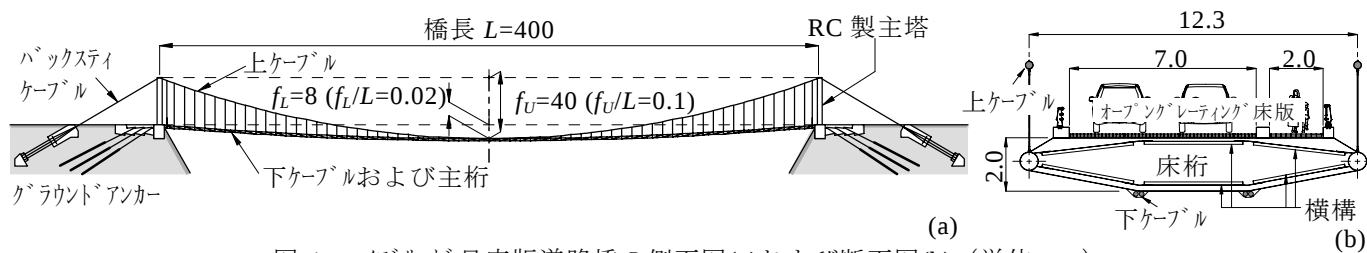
ハイブリッド吊床版道路橋の側面図(a)および断面図(b)（単位：m）
